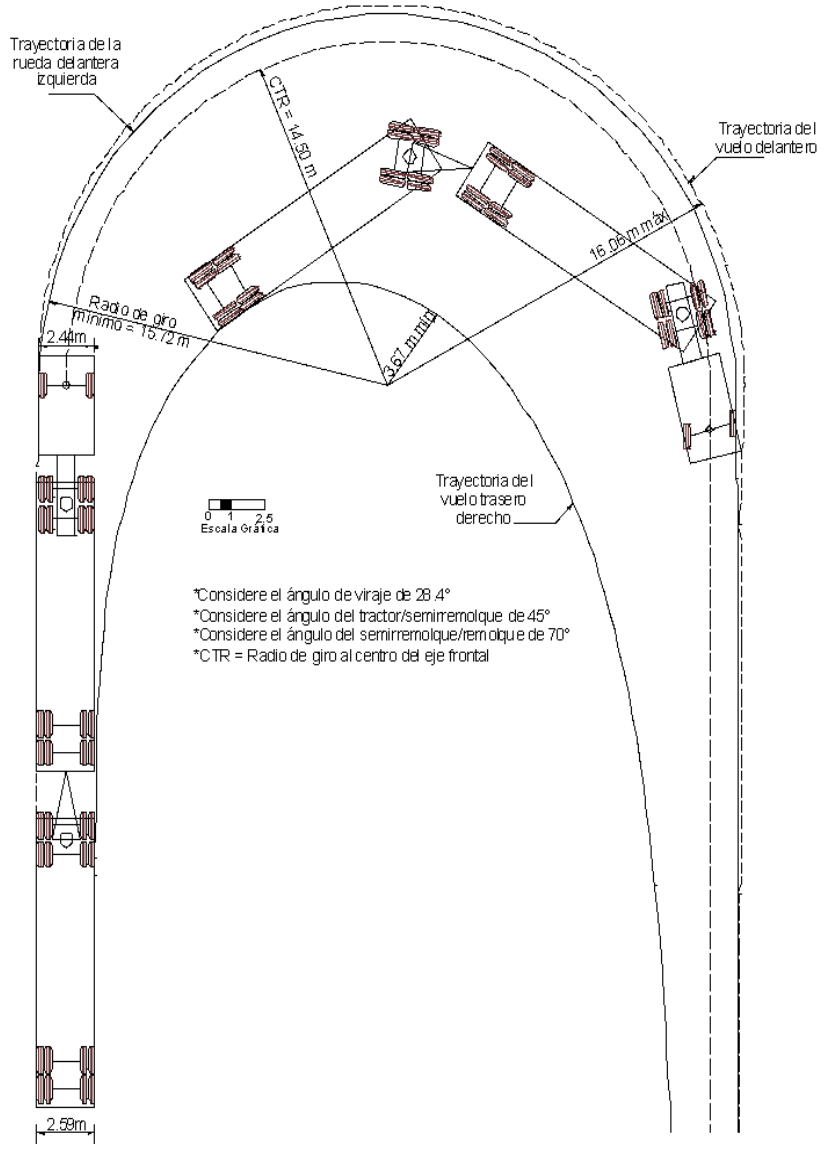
Dimensiones y trayectoria de giro del vehículo de proyecto DE-2970
